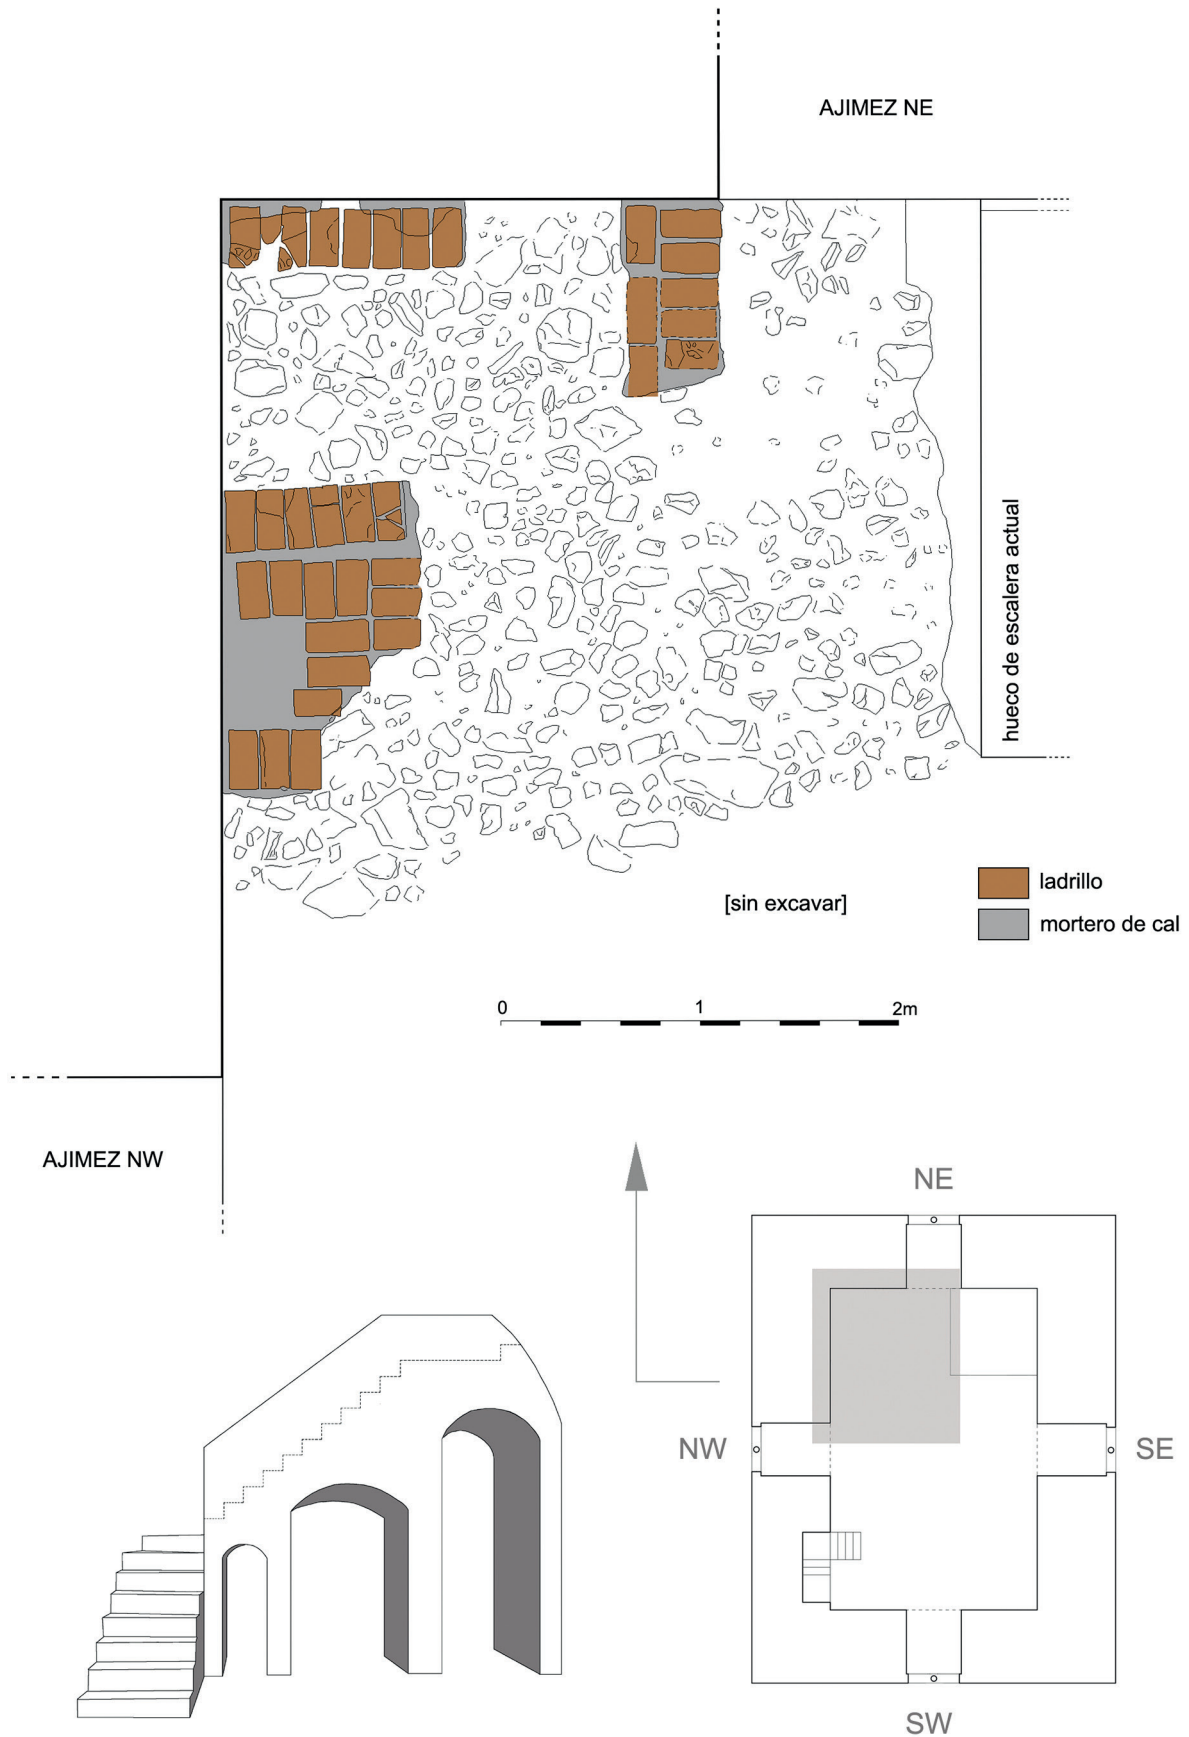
Planta Tercera. Planimetría de los restos conservados de la estructura de la escalera medieval original de época calatrava, siglo XIII (UU.EE. 218, 219 y 220), y pavimento de la sala asociado (U.E. 216), con propuesta de perspectiva reconstruida de la misma.
